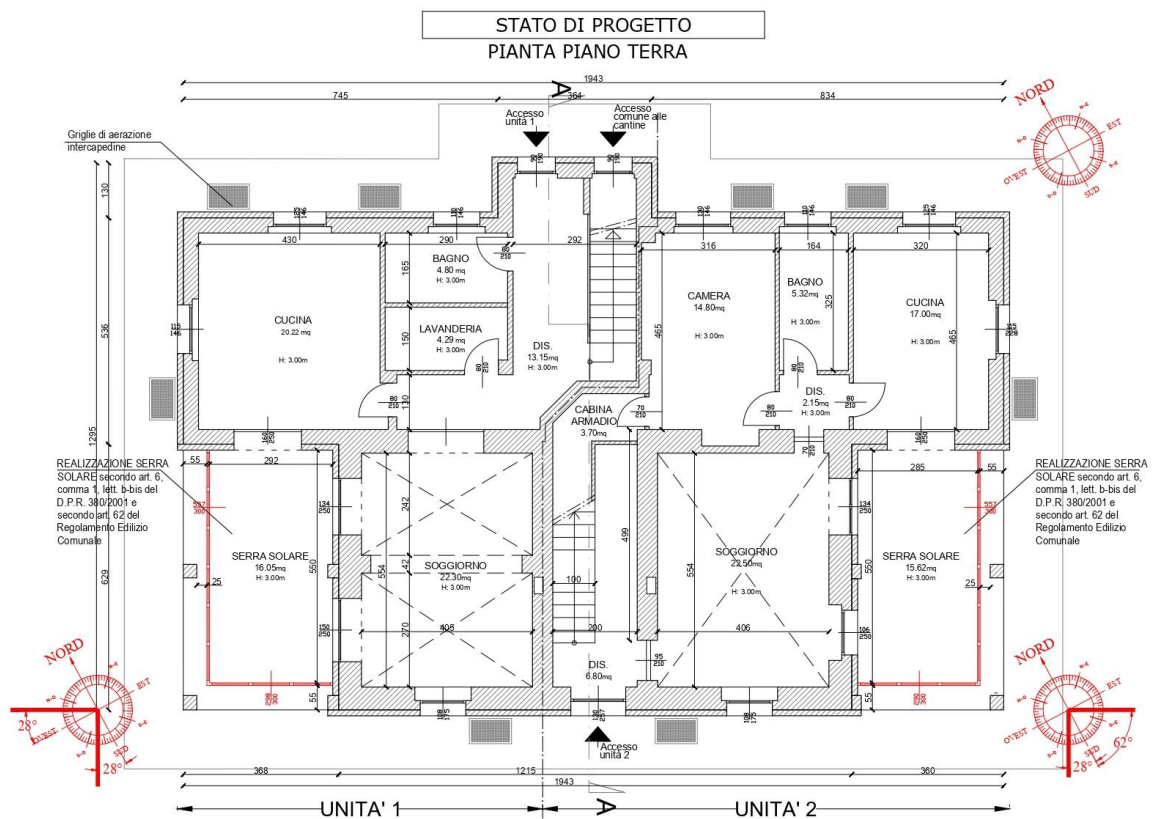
Pianta edificio, in rosso il progetto della serra solare
